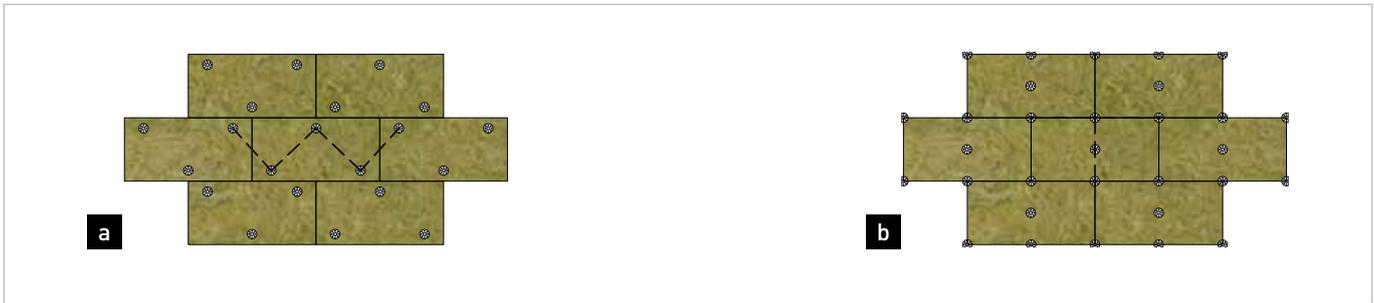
Rappresentazione grafica dello schema di posa a W e T dei tasselli per il fissaggio dei pannelli isolanti al supporto. a) Schema di posa a W; b) Schema di posa a T
